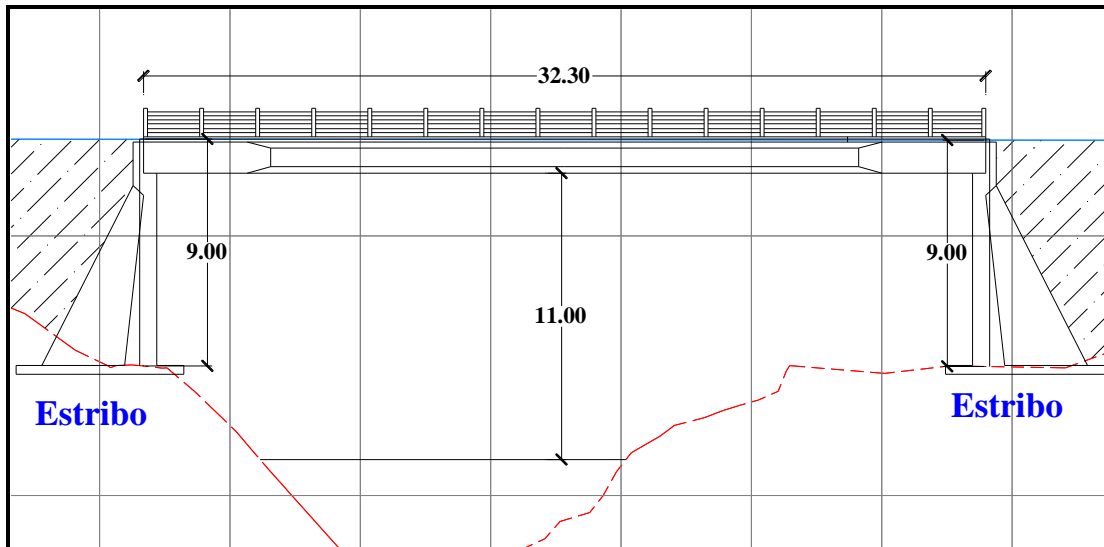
Perfil longitudinal de la alternativa 1, donde se muestran alturas de terraplén y la longitud pretendida del puente. (Fuente: SEDECA)
